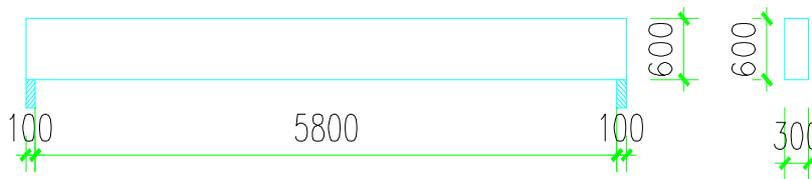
钢筋混凝土梁 (图中长度单位: mm)
